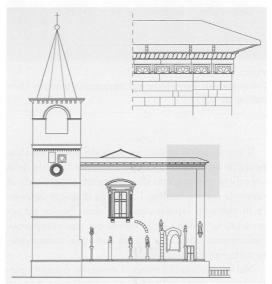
Prospetto est. Parete absidale e particolare (disegno dell'autore 2013)
